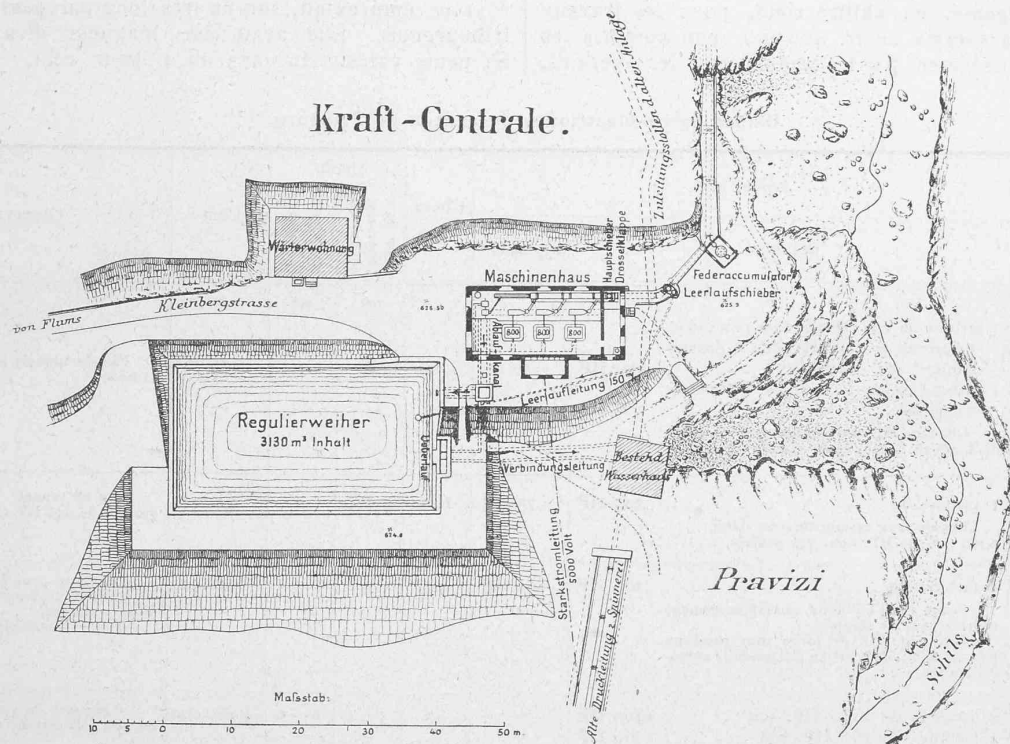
Lageplan der Kraft-Centrale. — Masstab 1:1000.
